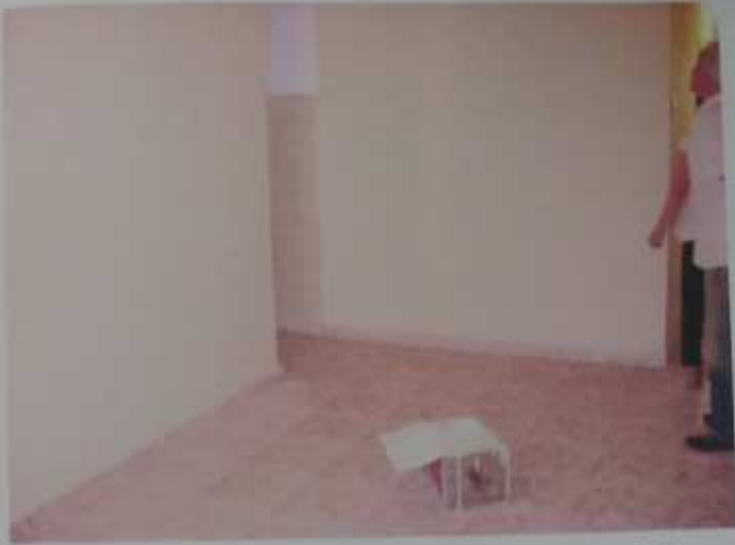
Vista interna do imóvel avaliando. Sala.
